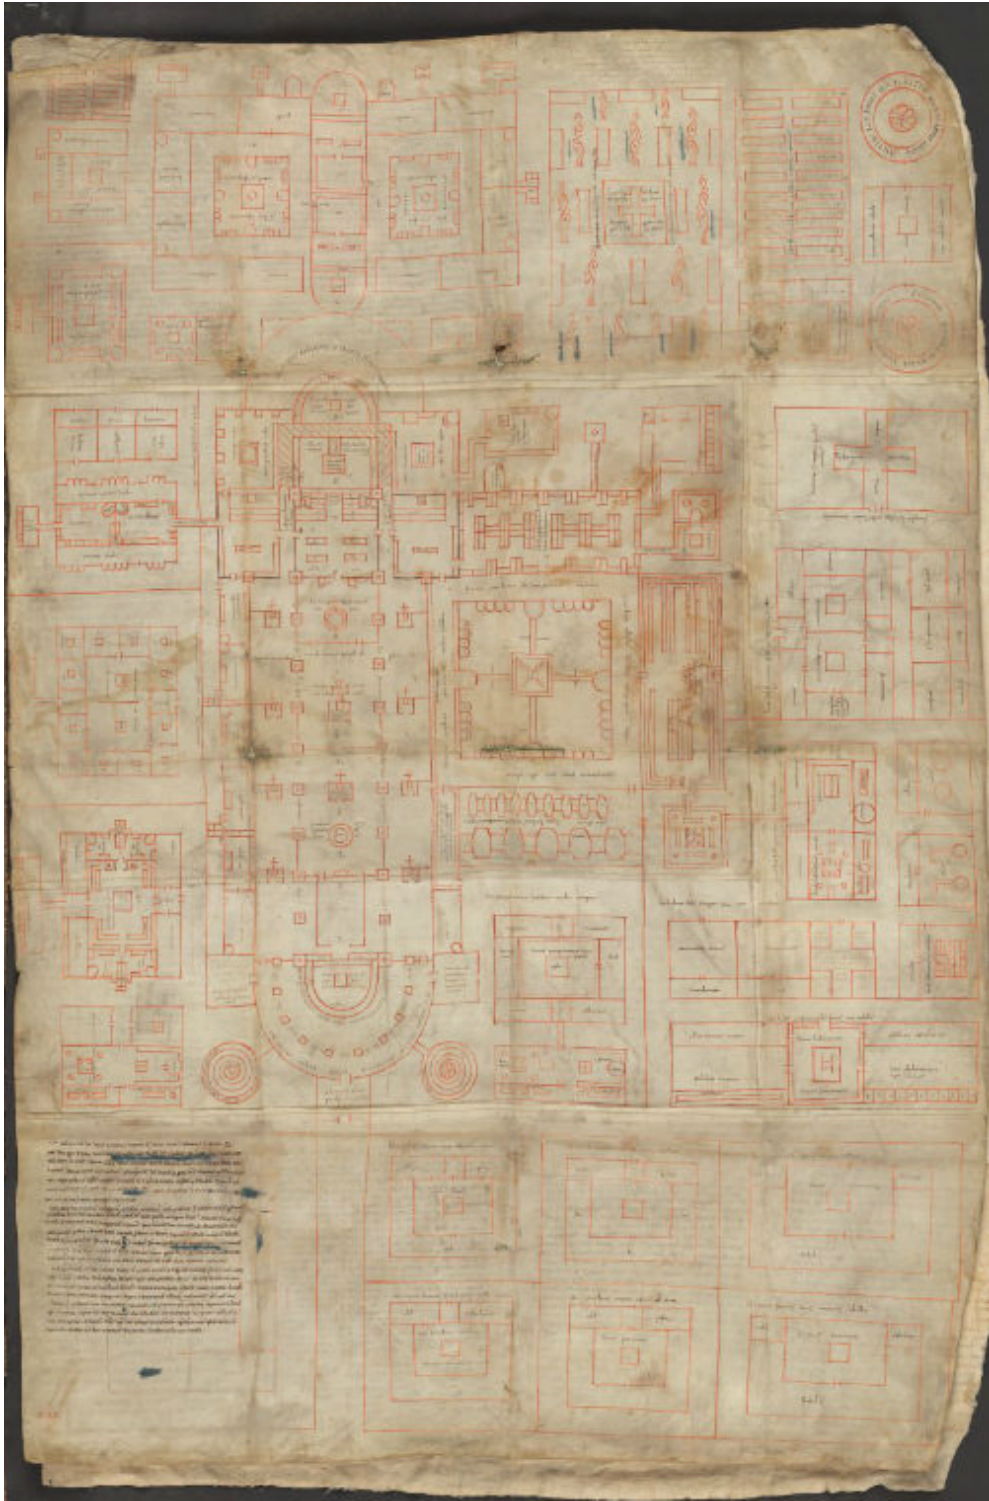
The Plan of St. Gall (ザンクト・ガレン修道院の平面図)
